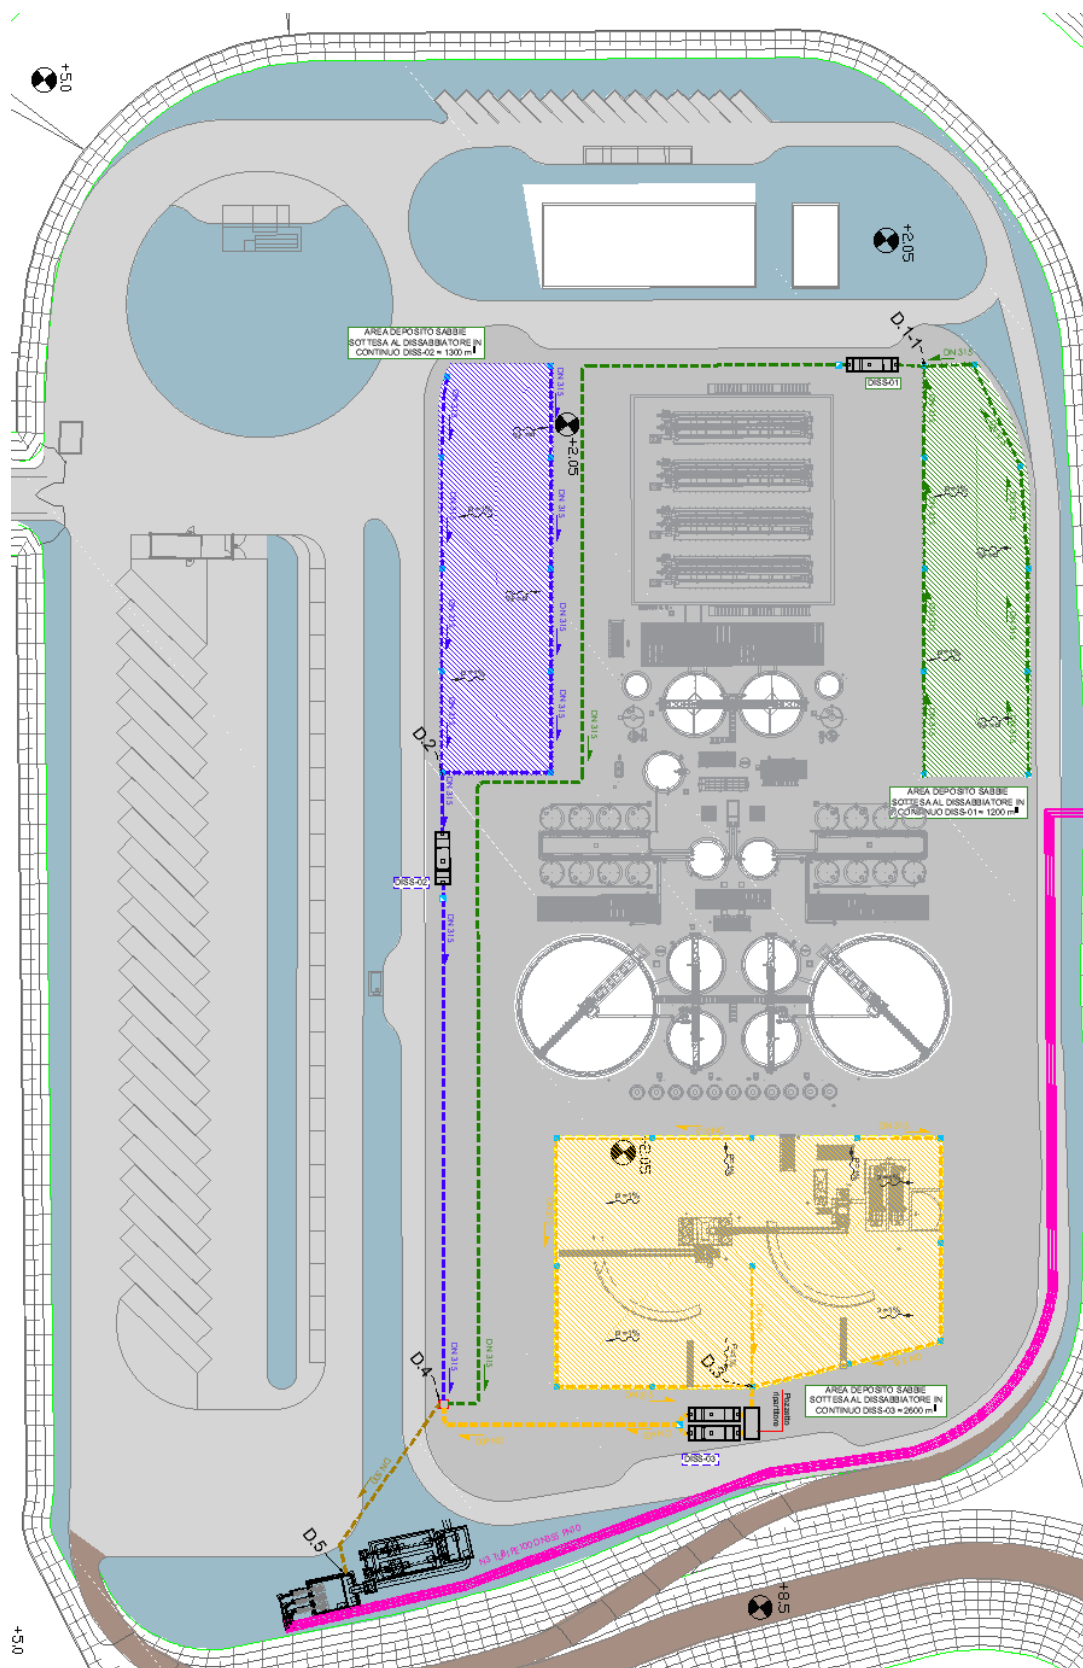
Schema planimetrico rete di drenaggio acque di dilavamento
